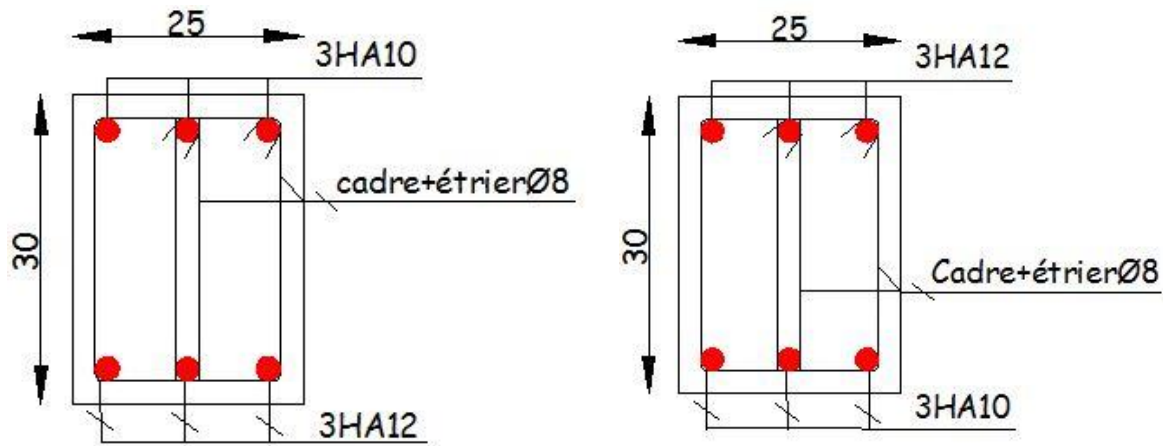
schéma de ferrailage de la poutre de chaînage en travée et en appui.
